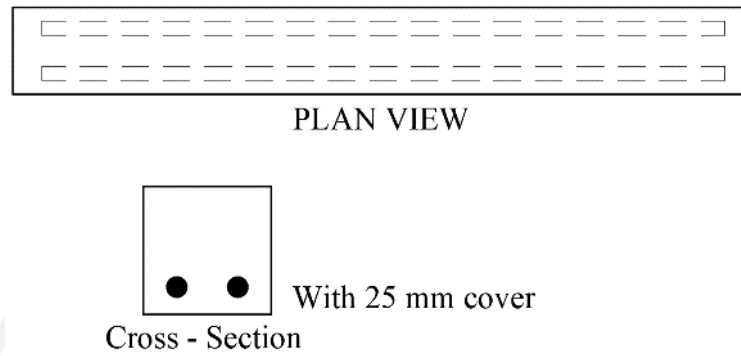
3 Beton kontrol dengan tulangan baja (Tipe 3)
